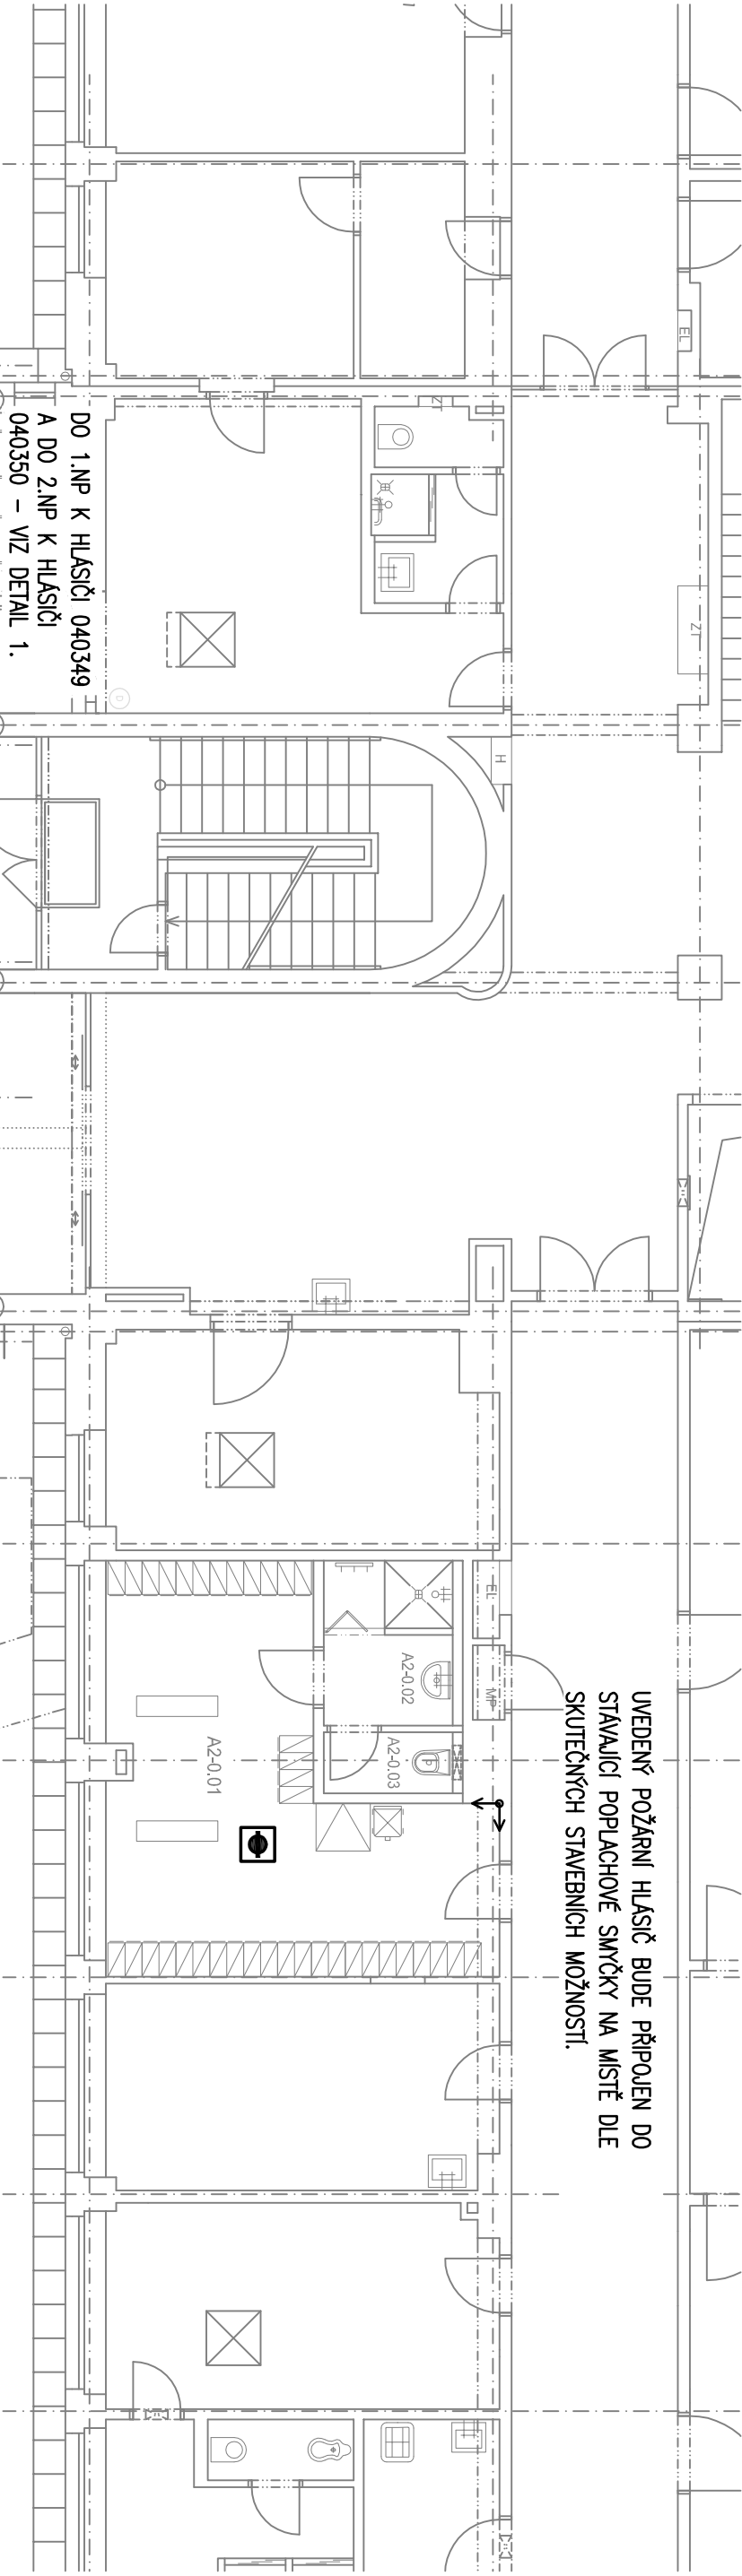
OBJEKT A5 – 1.NP A 2.NP (MĚŘITKO 1:100)
